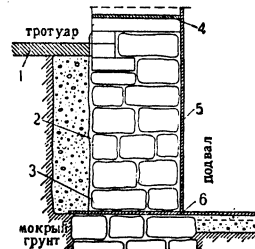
Бутовый фундамент, изолированный от грунтовых вод: 1—бетон (10 см), 2—мятая глина, 3—смола, 4—изолирующий слой асфальта, 5—цементовая штукатурка, 6—цементовая штукатурка или асфальт.
